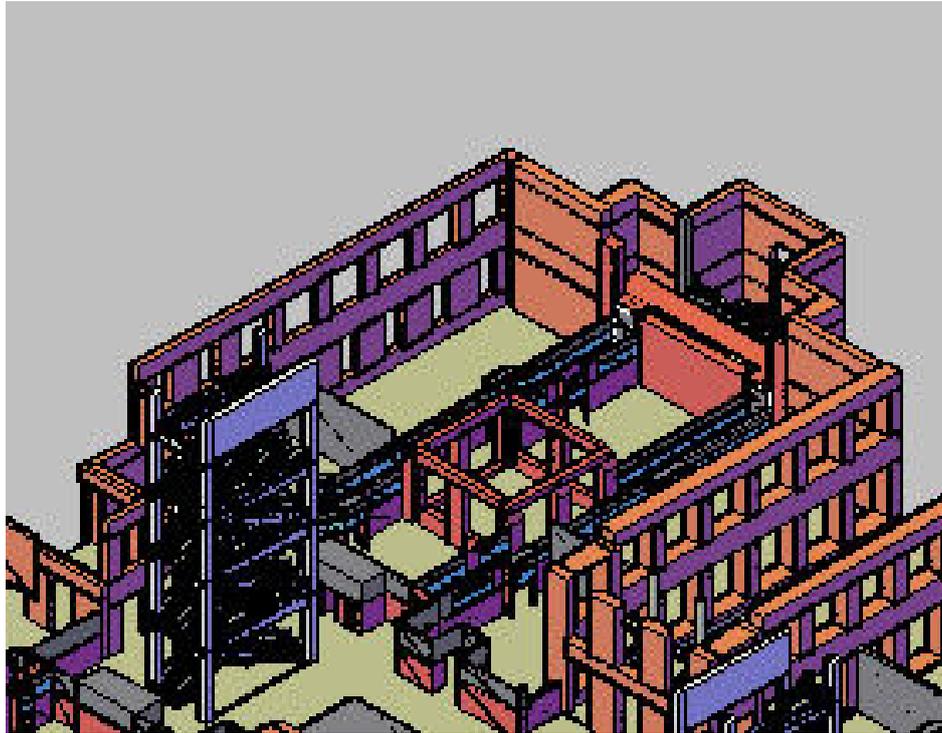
Paredes de ladrillo rojo de planta baja
